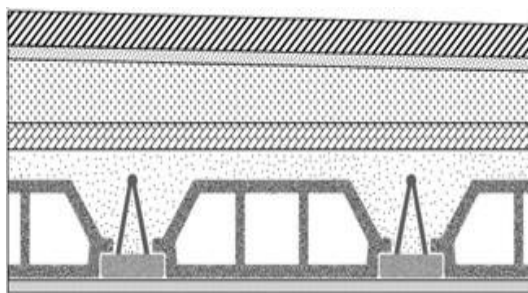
Coupe verticale du plancher terrasse à corps creux.
